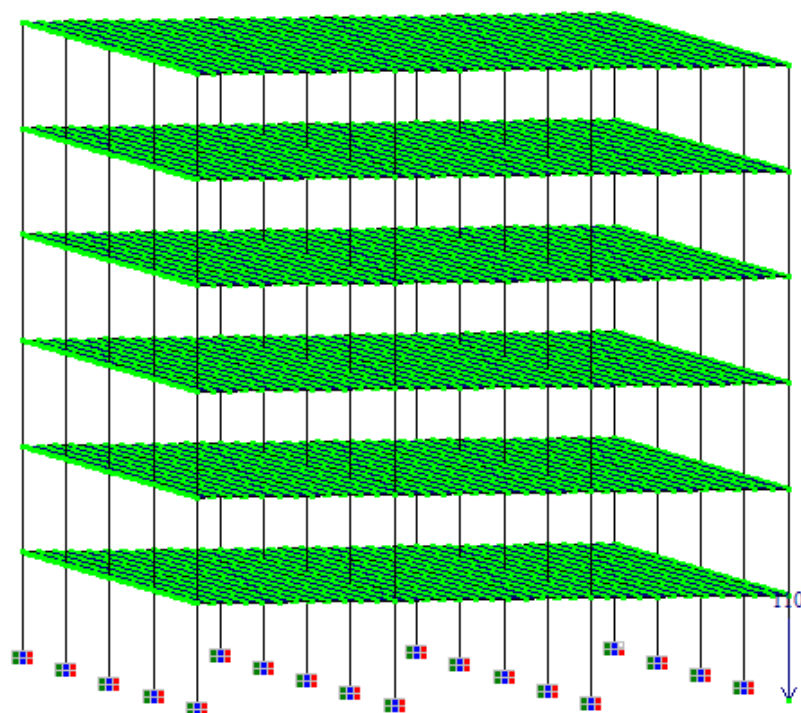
Schéma illustratif du modèle d'étude du bâtiment avec planchers sans hourdis à 6 niveaux avec un chargement vertical sur le poteau d'angle
